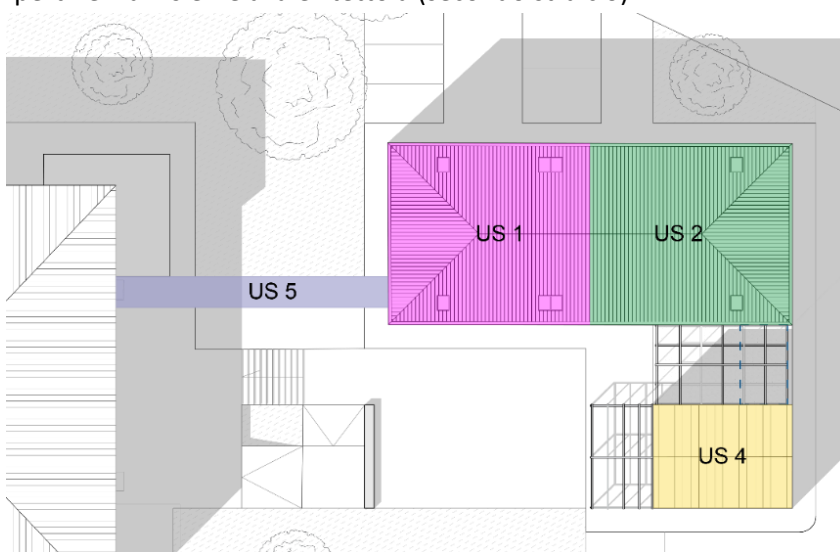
Planimetria allo stato di progetto_ Unità Strutturali
